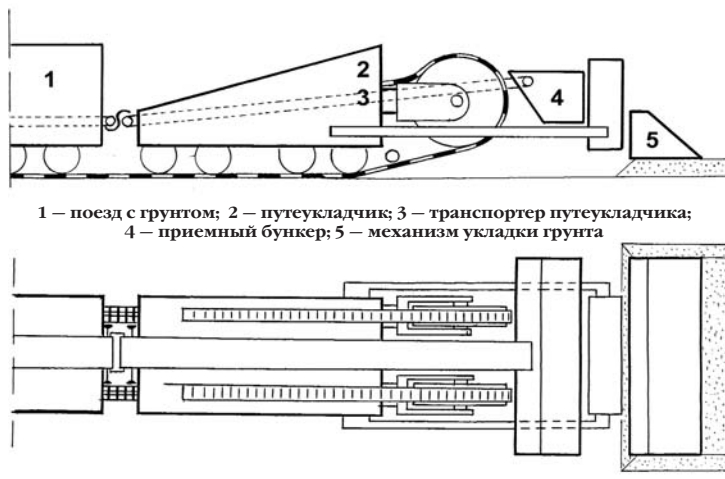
Принципиальная схема механизма для непрерывного процесса укладки монтажного рельсового пути и слоя грунта в сооружаемую насыпь
